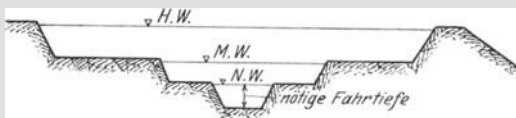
Bettquerschnitt im Mündungsgebiet mit bes. HW., MW- und NW.-Bett.
